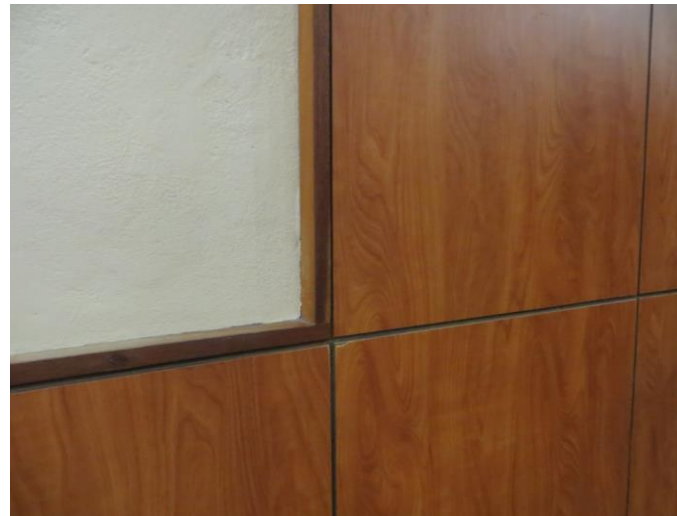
y 146. Detalles de los paneles de revestimiento en las columnas curvas y en las paredes de las escaleras.
